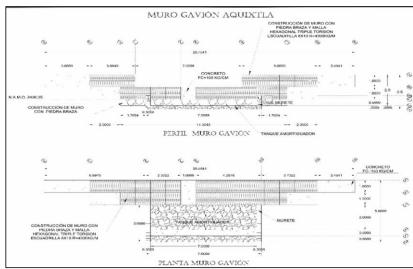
Características del muro gavión filtrador para el proyecto.
